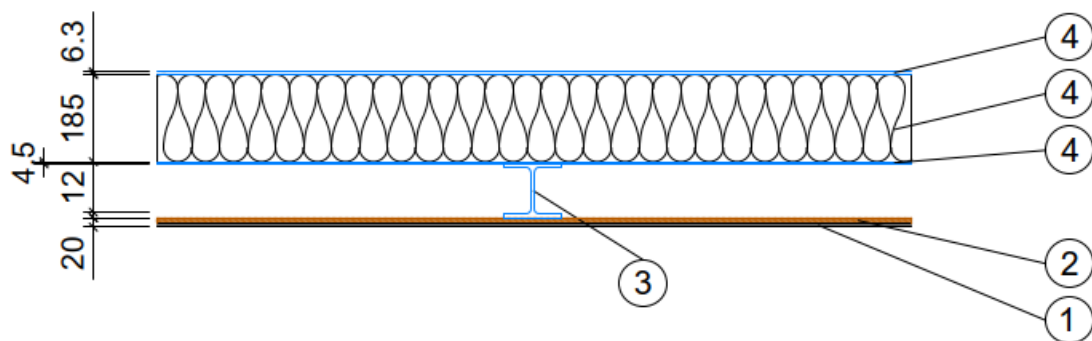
Aufbau Stahldach mit Sandwichpaneelen
